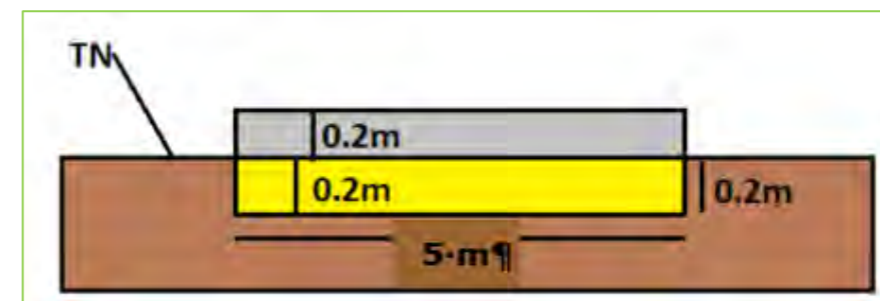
Coupe type d'une piste lourde (source : PHOTOSOL)
